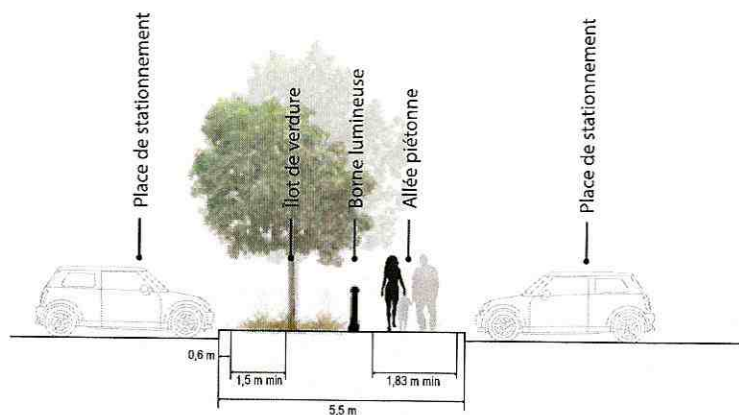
Coupe schématique d'une allée piétonne à l'intérieur d'un stationnement
